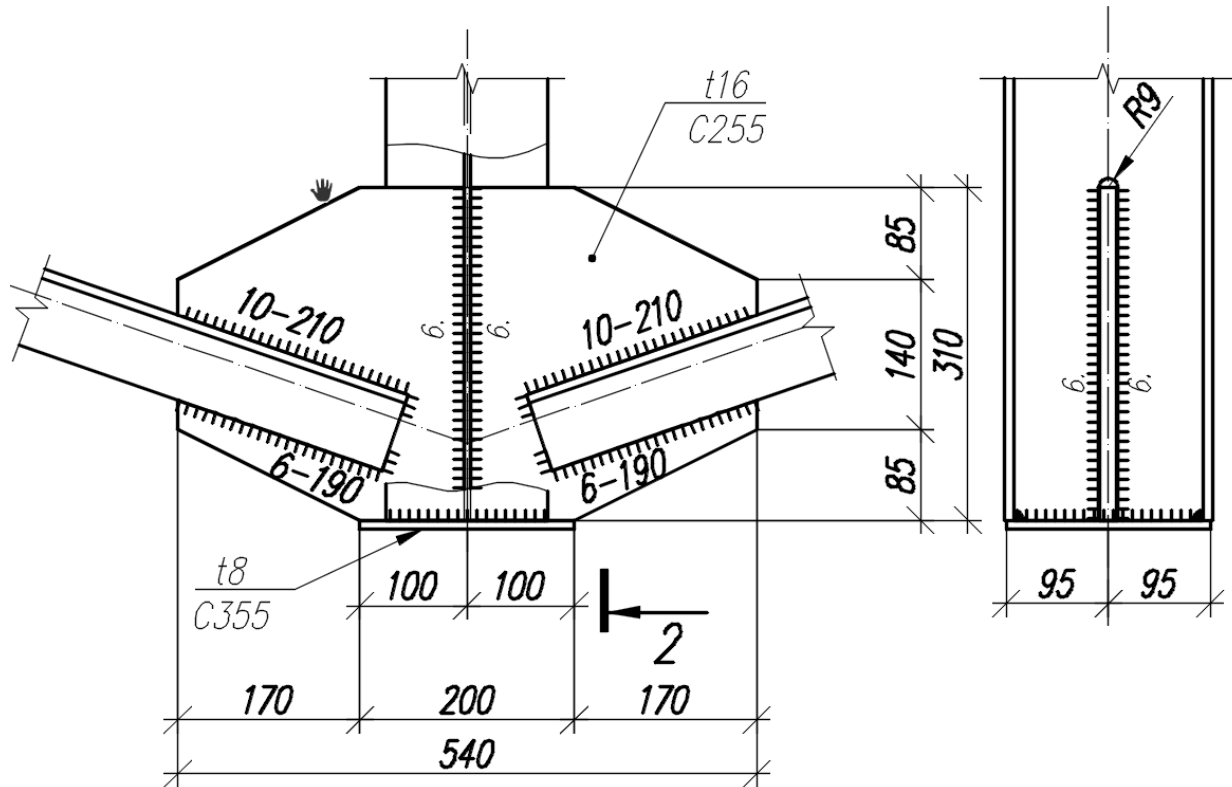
Узел 3 подстропильной фермы ФП-12-52.
